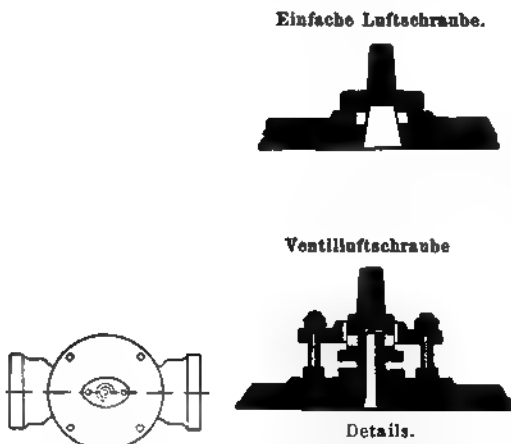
Spunkkasten an Entlüftungspunkten mit Ventilluftschrabe und Einbaugarbeit
